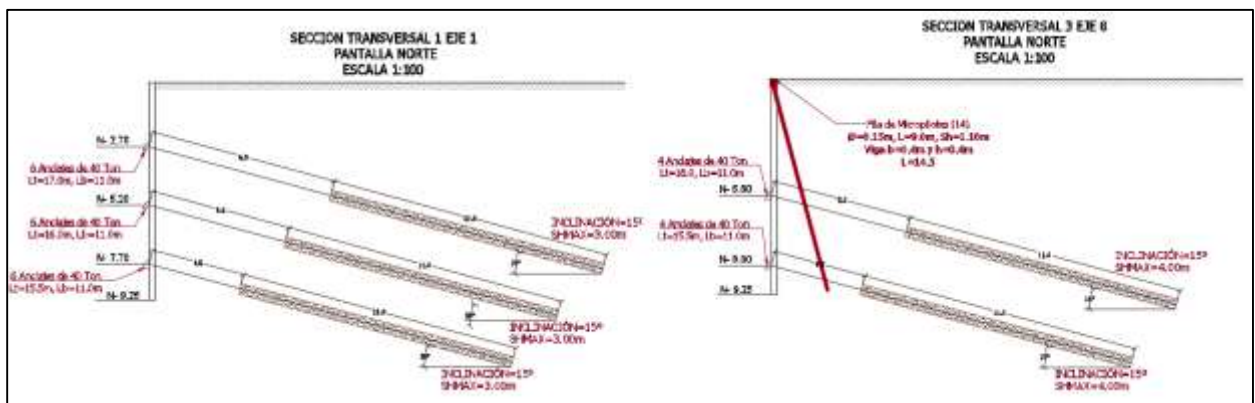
Secciones Transversales Pantalla Norte - Proyecto San Agustín
